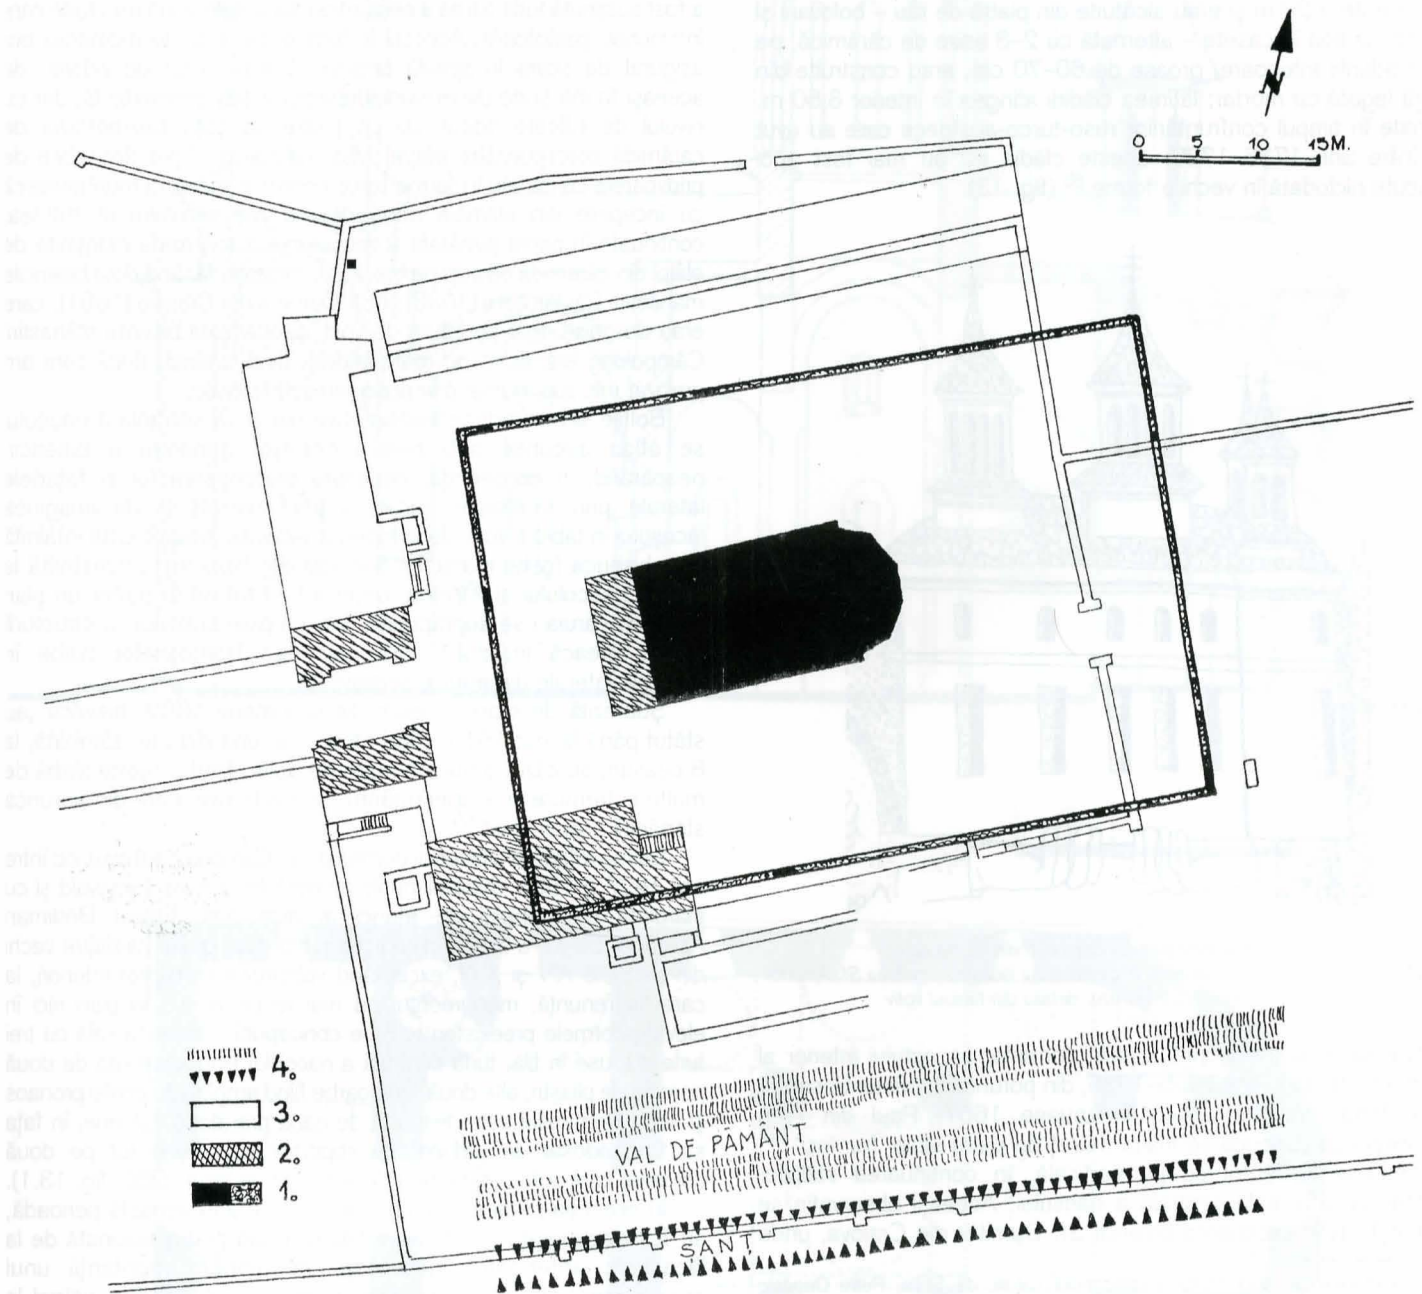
Ansamblul domnesc din Câmpulung. Plan de situație:
